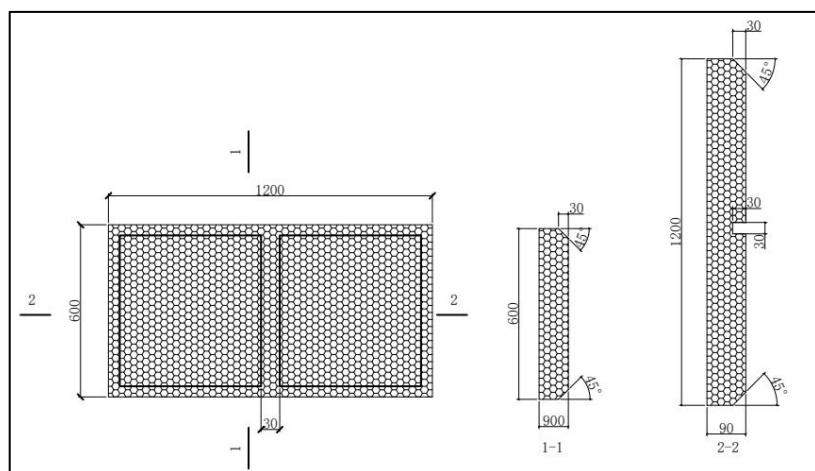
倒置保温防水屋面保温板排水通道构造示意图
